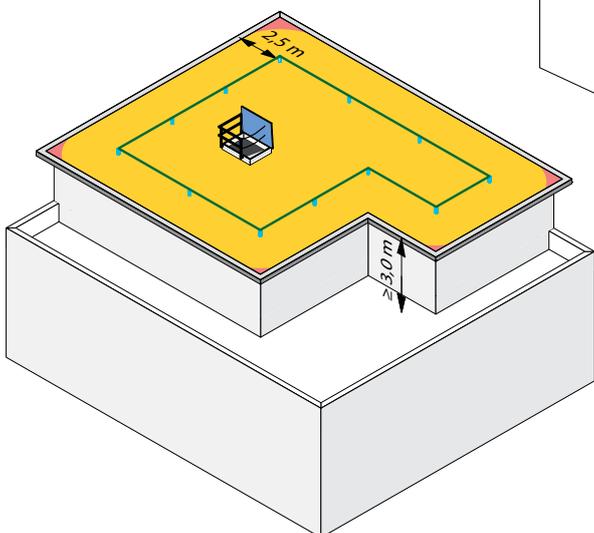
Classe di equipaggiamento 2: utilizzare un sistema di cavi permanenti se lo spazio dell'architrave è ridotto, ad esempio per terrazze parapetto o edifici con altezza inferiore a 6,25 m.
